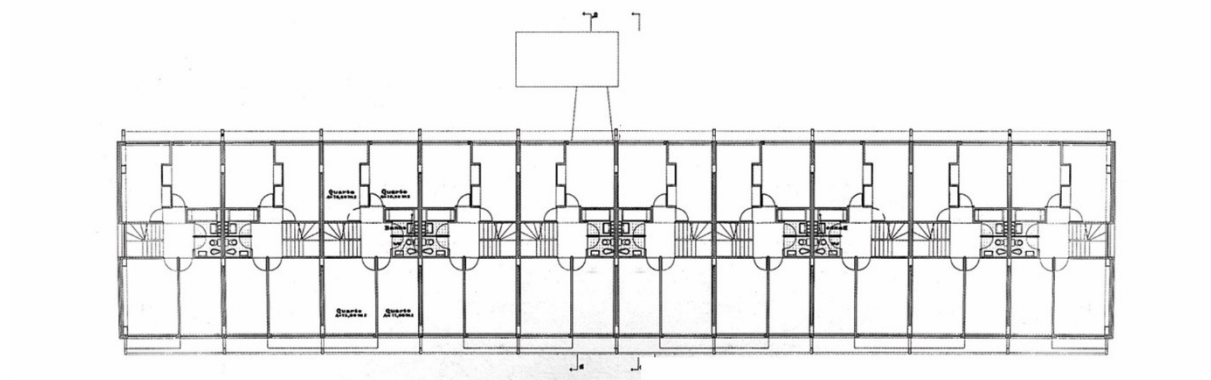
Planta do piso superior dos duplexes (1:500).
